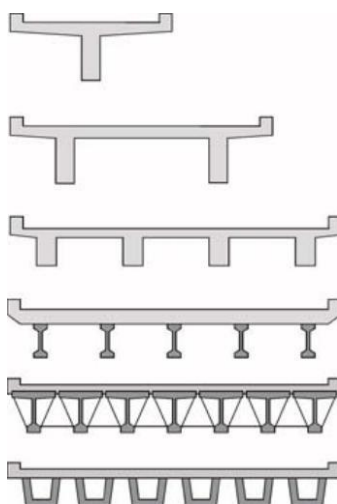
Sección transversal del puente tipo 01, losa sobre vigas
